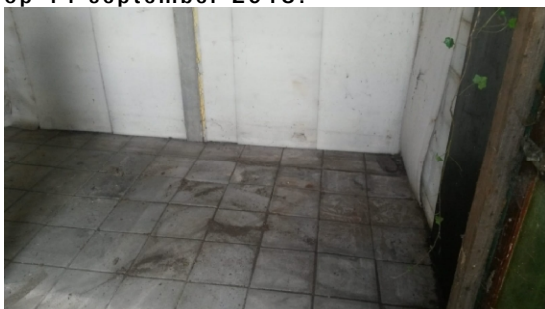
Locatie tijdens locatie-inspectie op 14 september 2018.
